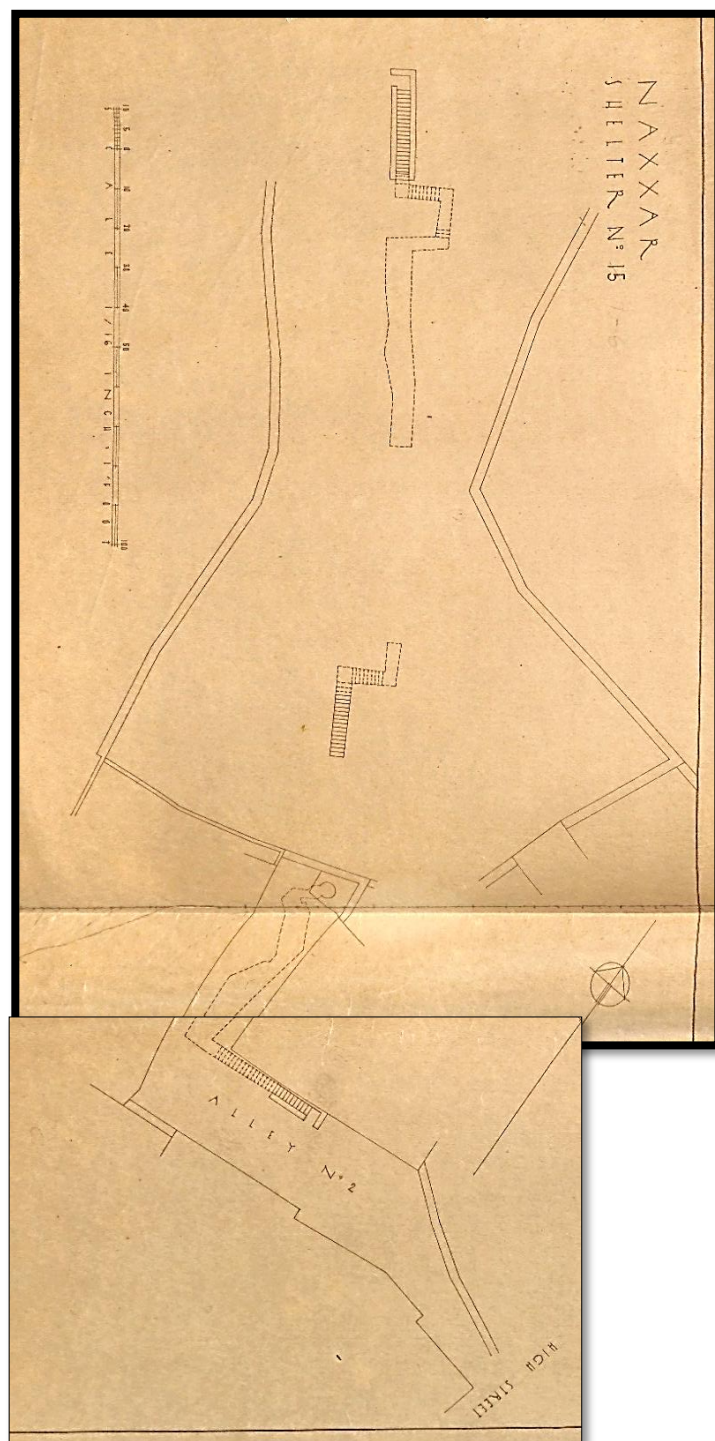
Planta do Abrigo nº15 (6) "Alley nº2)
